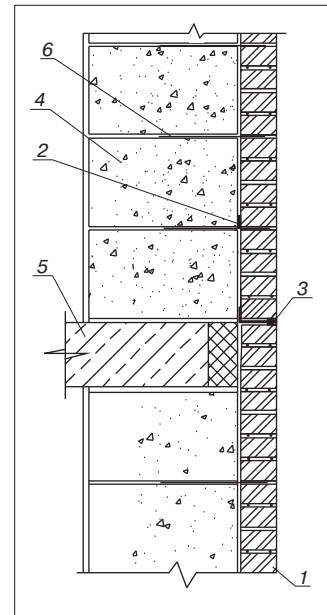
Стена из газобетонных блоков: 1 — облицовочный кирпич; 2 — опорный уголок; 3 — деформационный шов; 4 — утеплитель (газобетонные блоки); 5 — перекрытие; 6 — анкер
